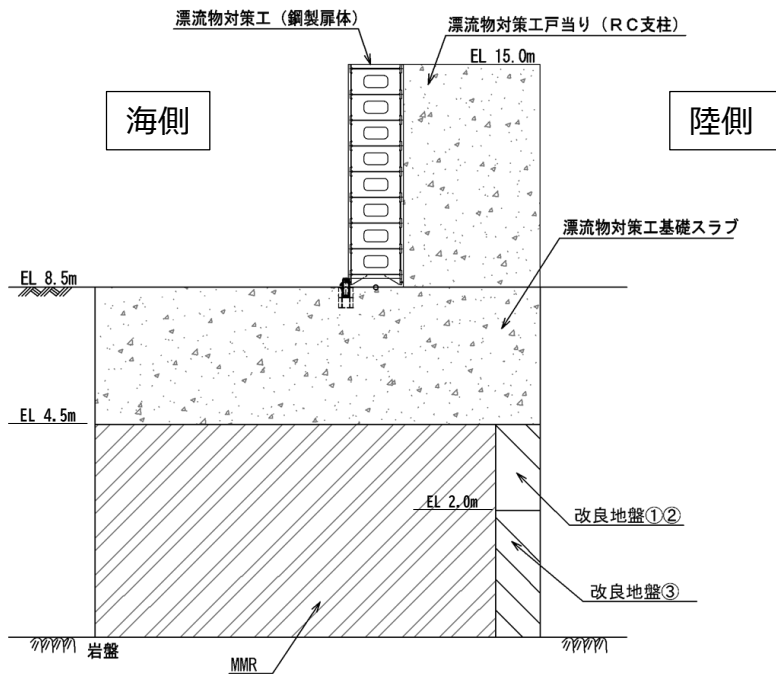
(2) 漂流物対策工の構造図(基礎断面図, C-C断面)
